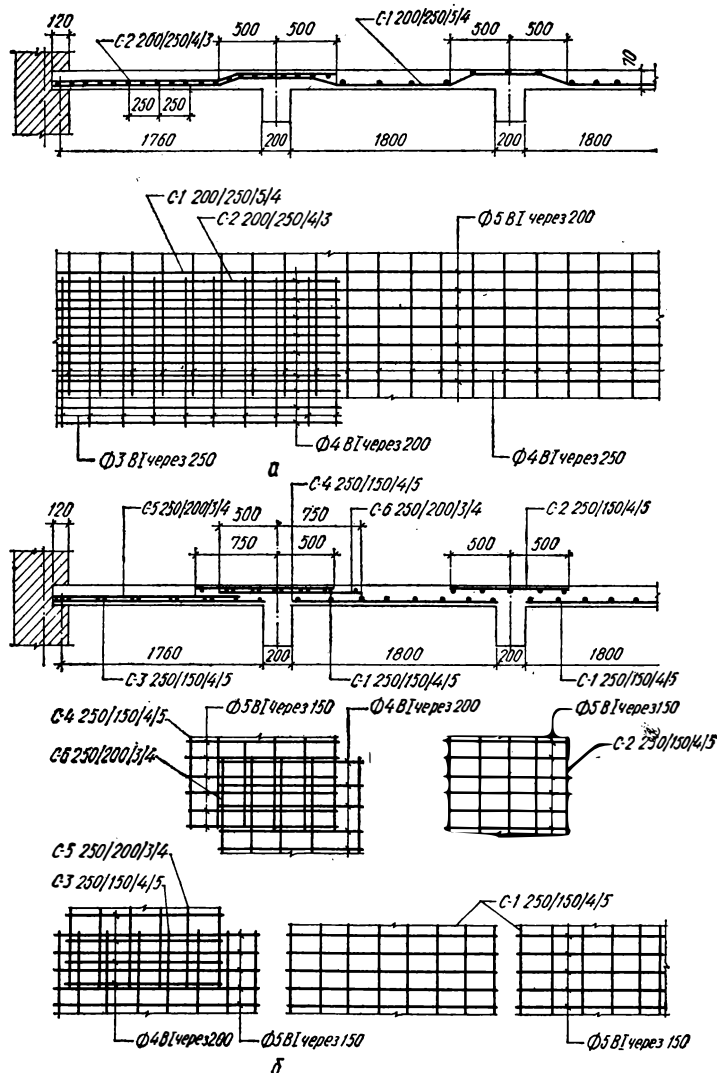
Армирование плиты сварными рулонными сетками:
